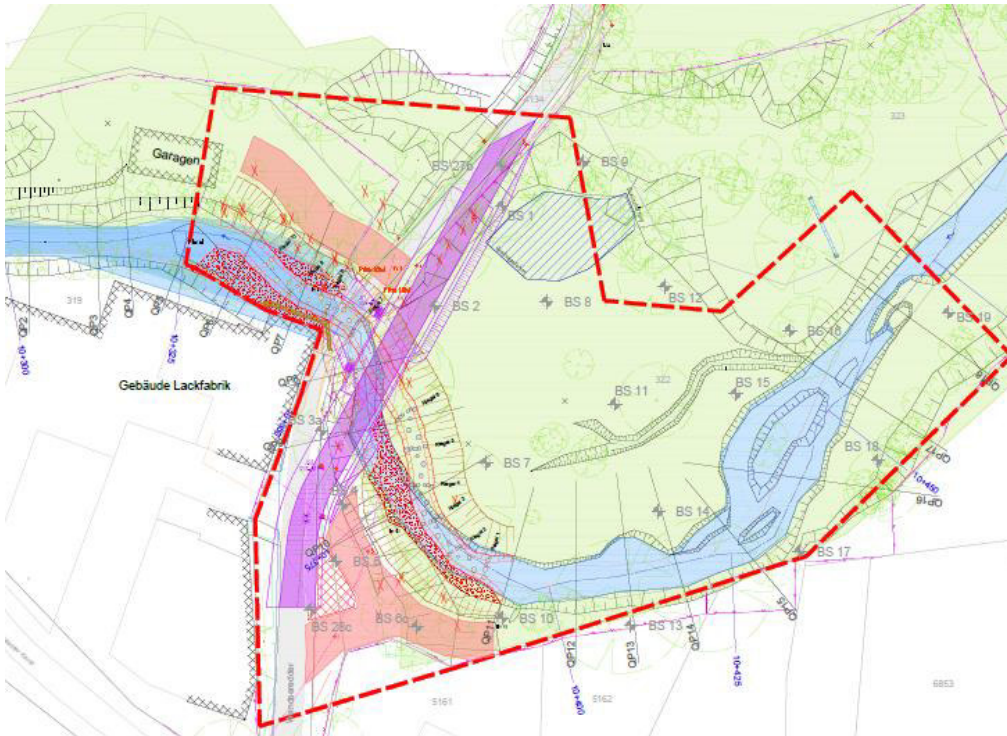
Lageplan FAA mit Baustraßen (rosa) und Brückenneubau (lila, schematische Darstellung) u. temporärer Baugrube (braun schraffierte Böschung) (Auszug BIOTA 2021b)
